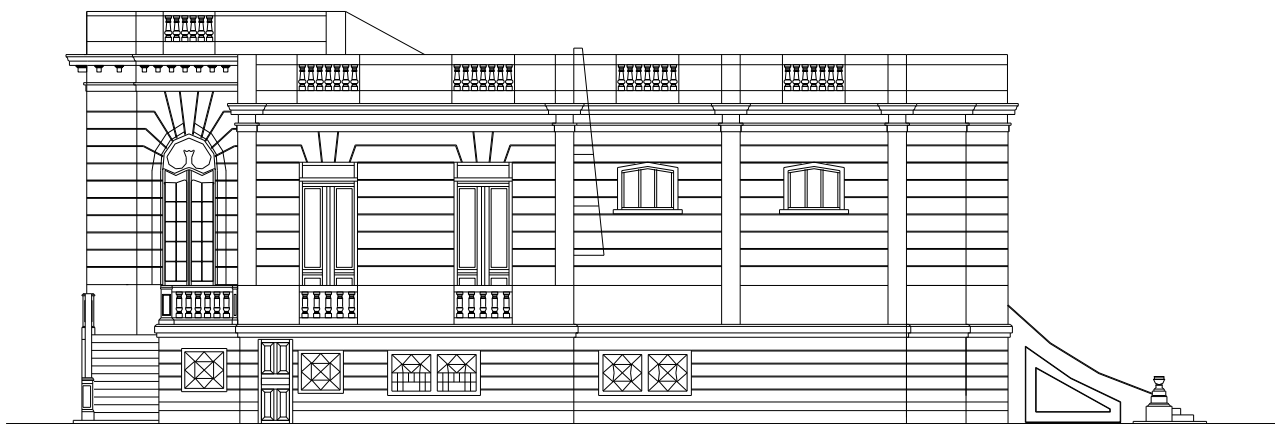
Fachada Norte, Proyecto de Restauración de la Casa del Lago.
